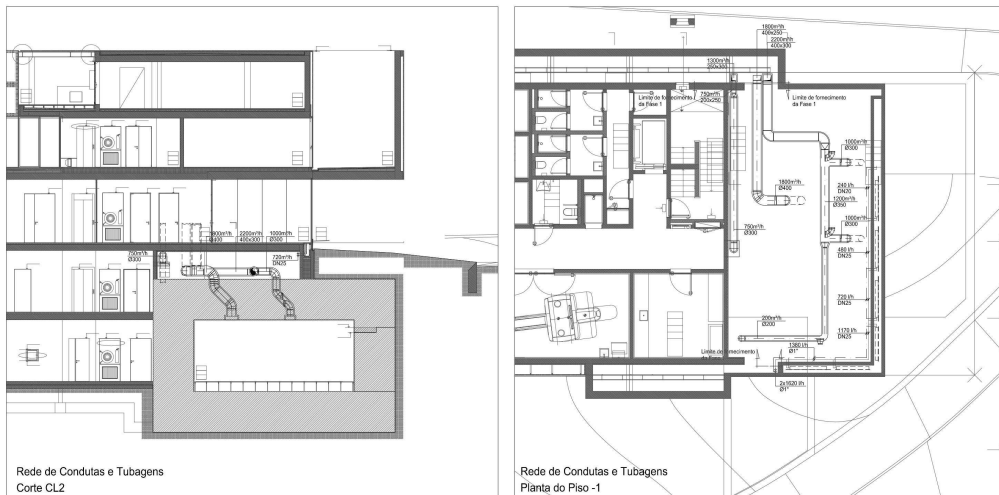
Rede de condutas e tubagens (corte e planta do piso –1)
